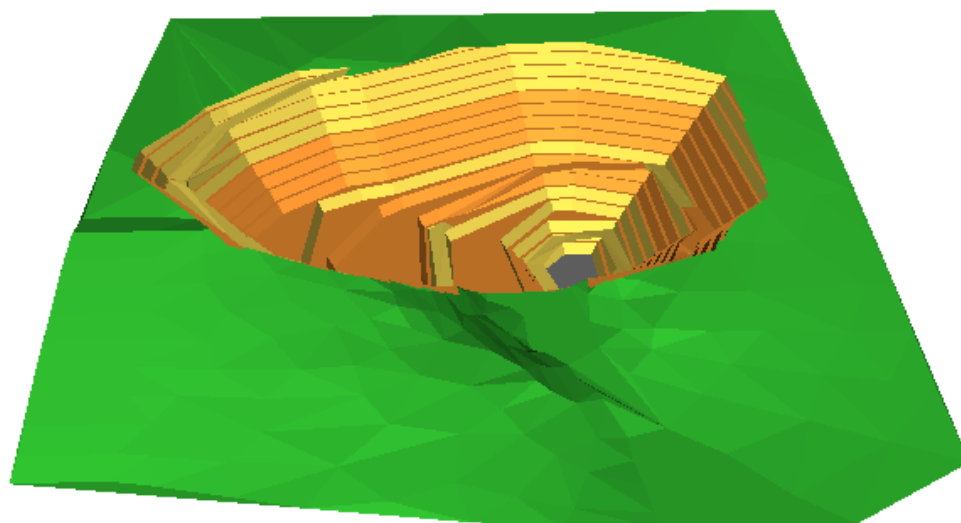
Vista en planta pit operativo Caso Zinc.
